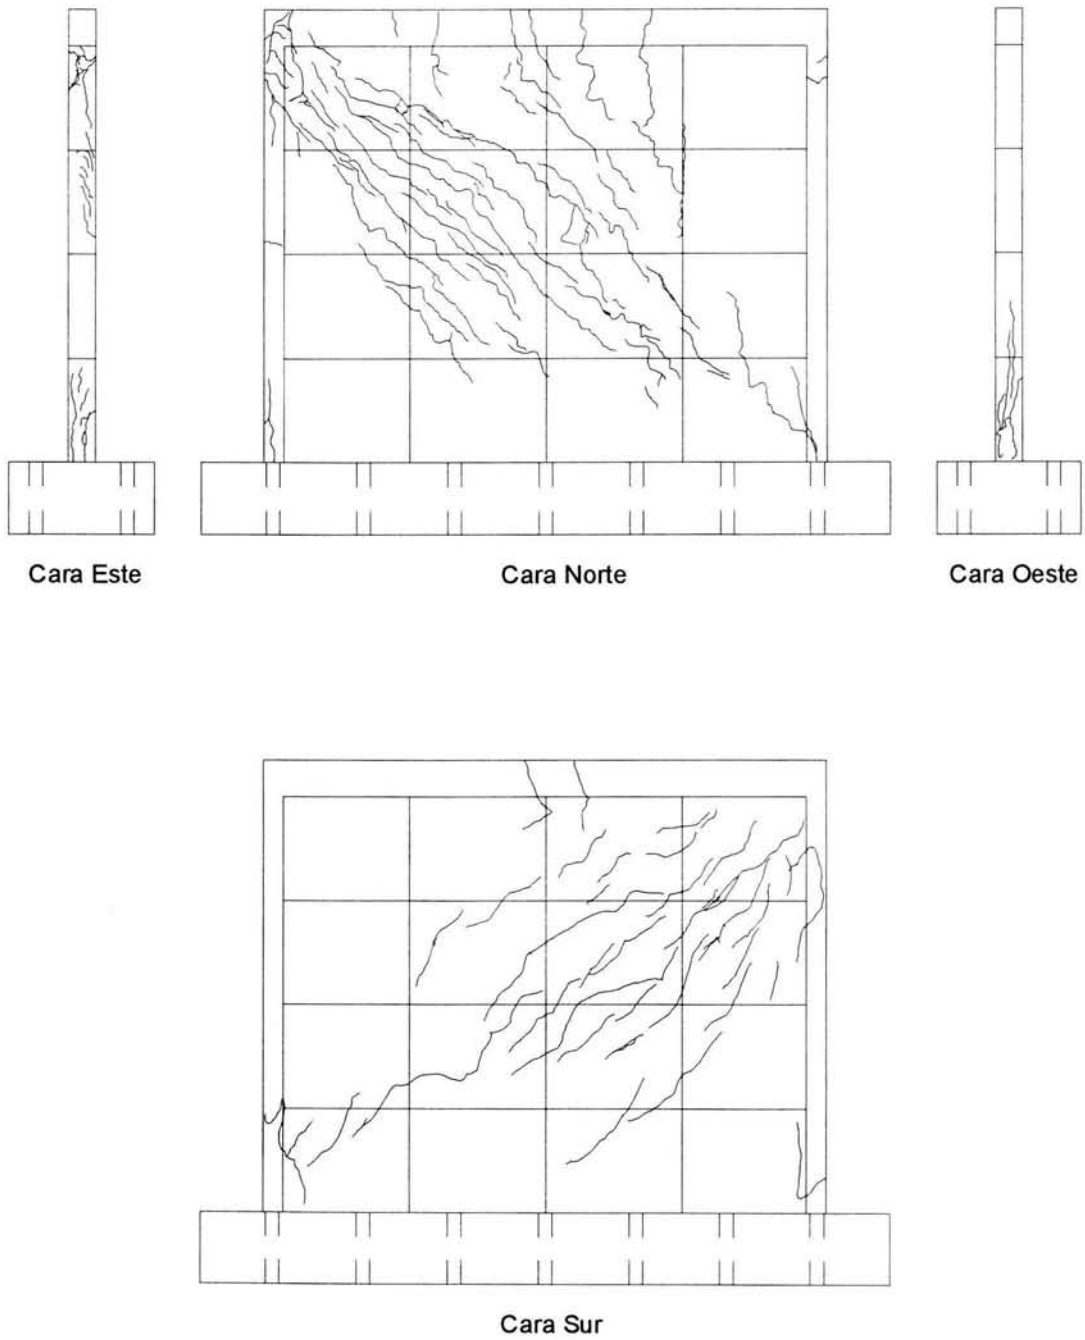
Patrón de agrietamiento del espécimen MRA-1R
